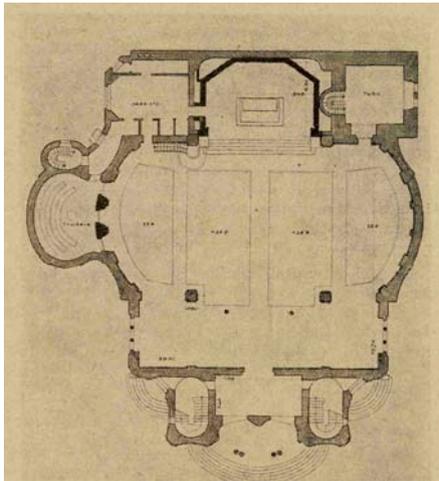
Pauluskirche, Grundriss des Nachkriegszustands
